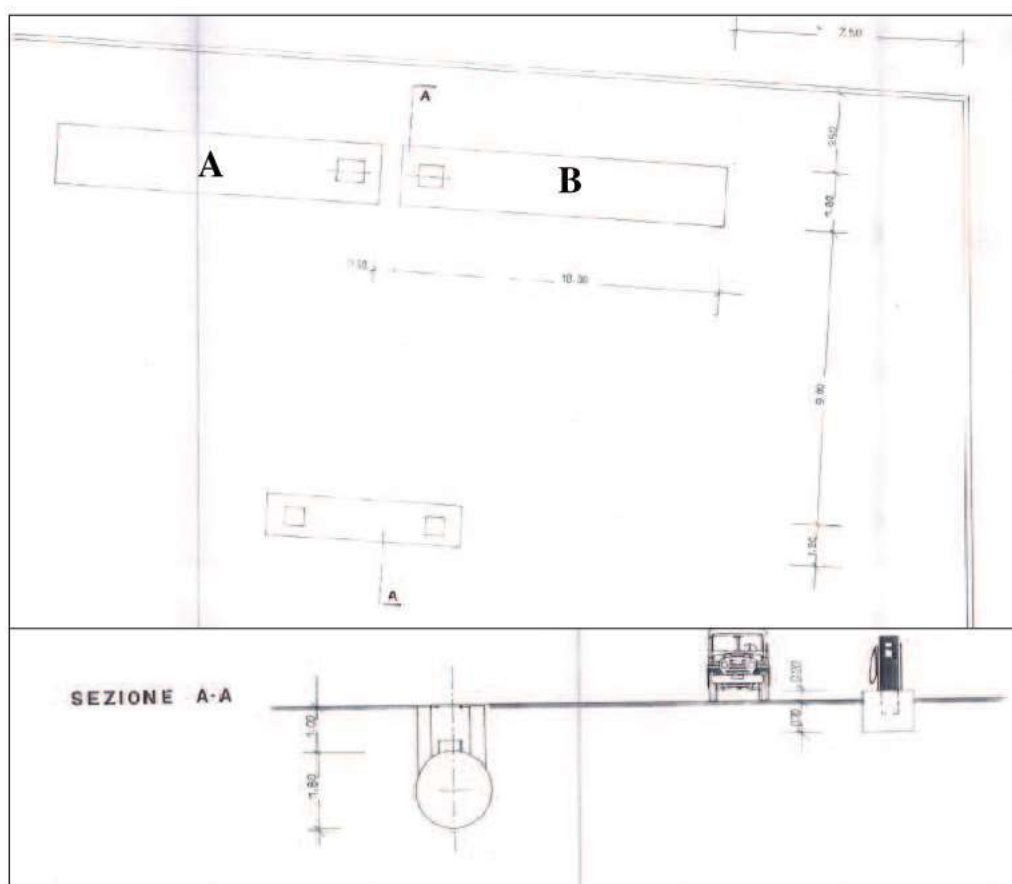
pianta e sezione dei serbatoi interrati per autotrazione.
